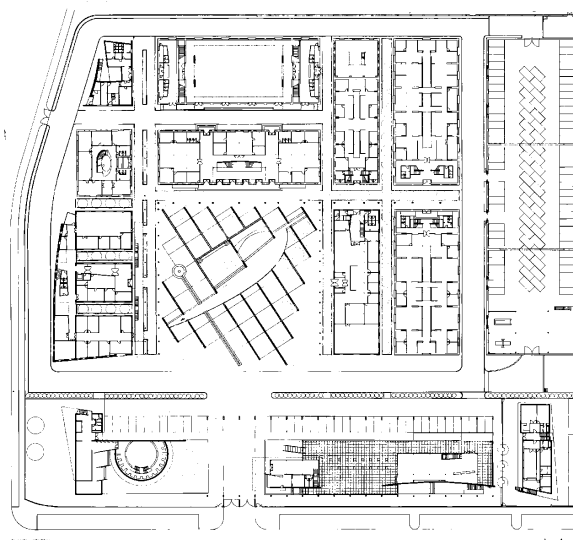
Planta general. Estado actual. (Fuente: SV60 Cordón & Liñán Arquitectos)
